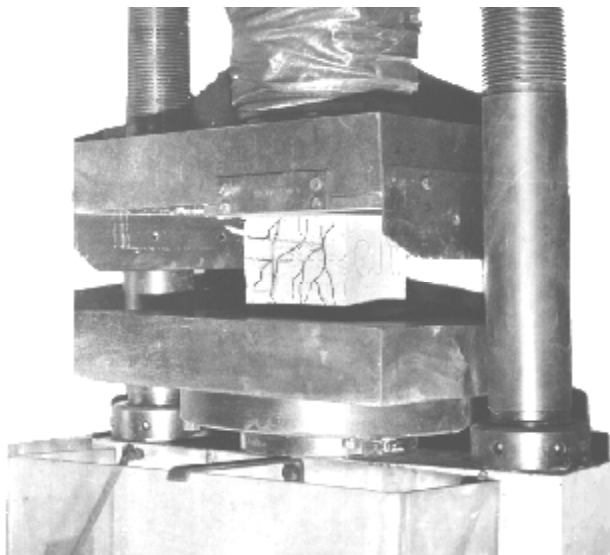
Формирование трещин в бетонном кубике под действием сжимающей нагрузки
